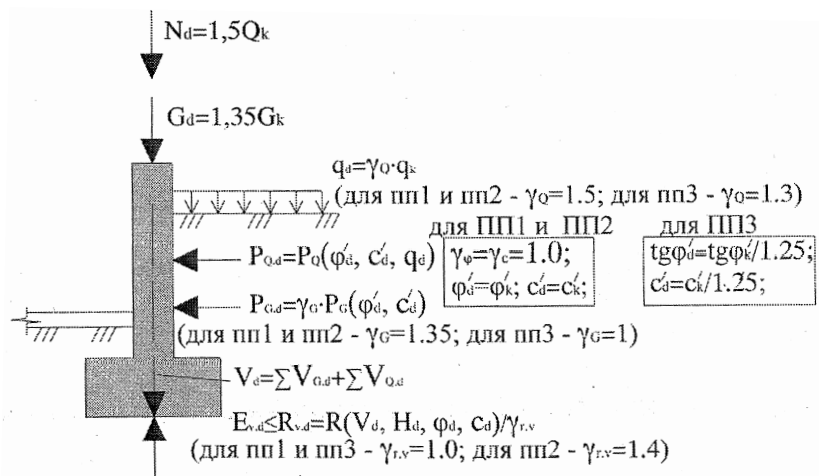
Принципы подходов ПП 1 – ПП 3 (DA 1 – DA 3) к проектированию плитных фундаментов с использованием частных коэффициентов (вариант вертикального равновесия при неблагоприятных сочетаниях воздействий)
